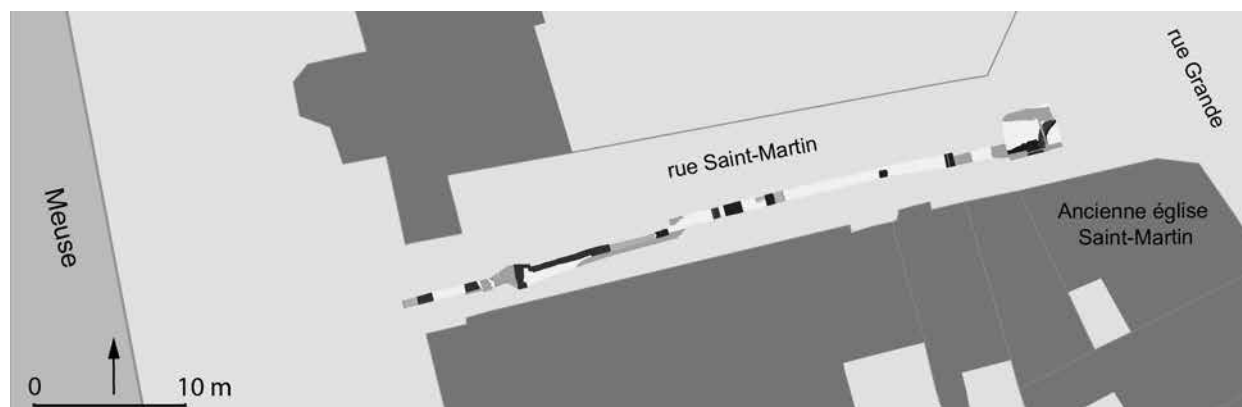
Plan de la tranchée d'égouttage sur fond cadastral.
